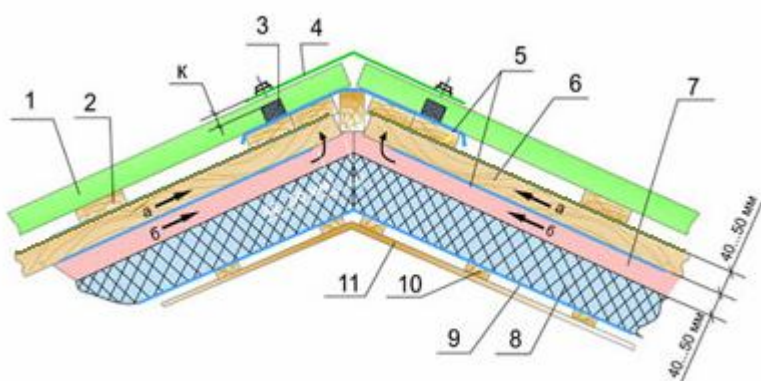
Монтаж кровли. Укладка гидроизоляционной пленки
